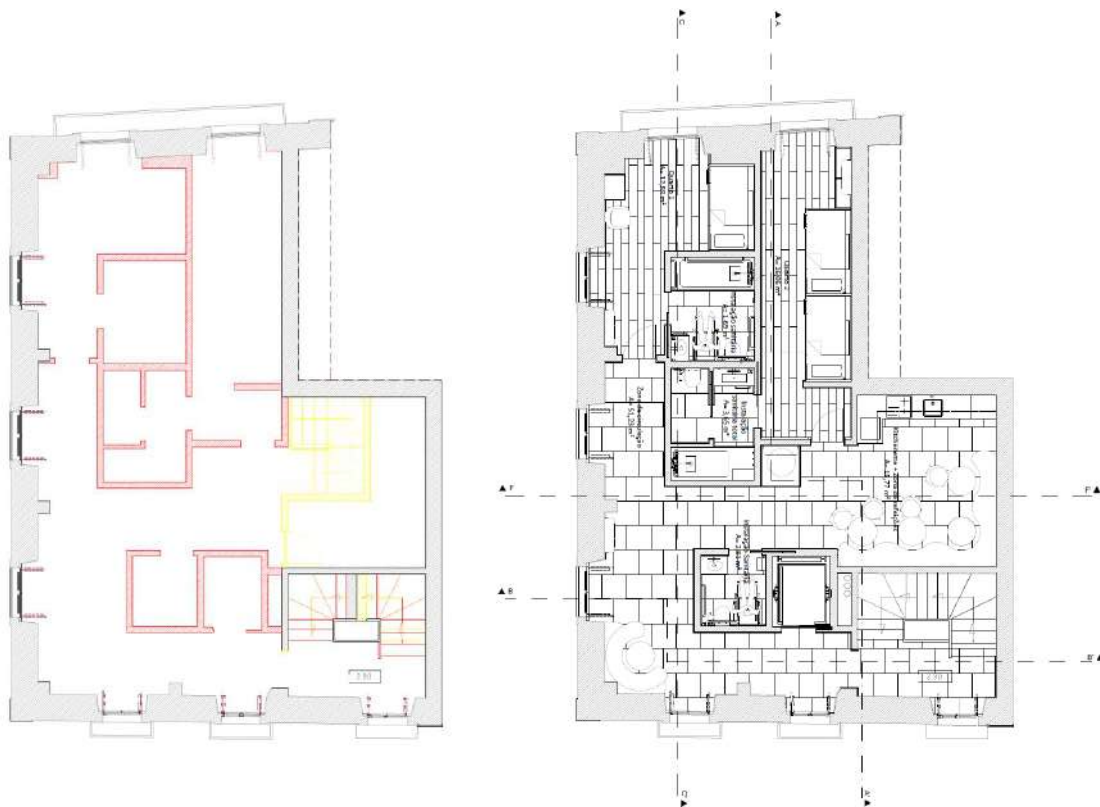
Planta de Alterações e Planta de Apresentação (Piso 1)
